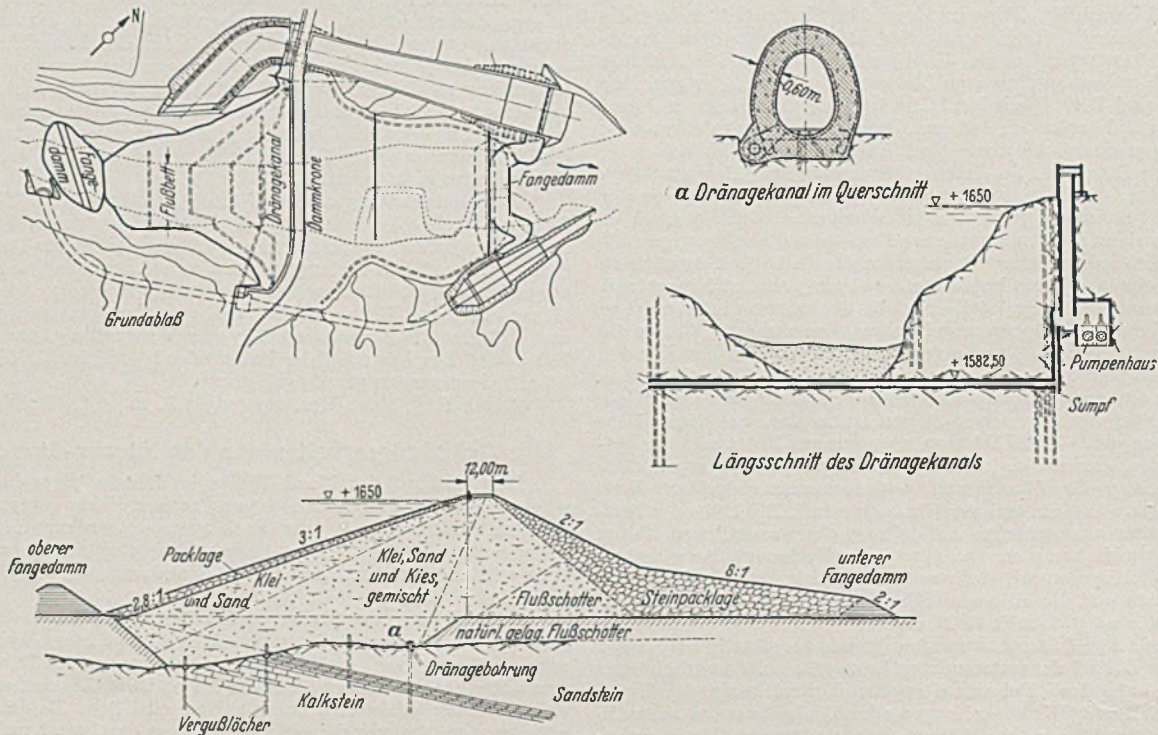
Lageplan und Schnitte zum Alcova-Damm.
